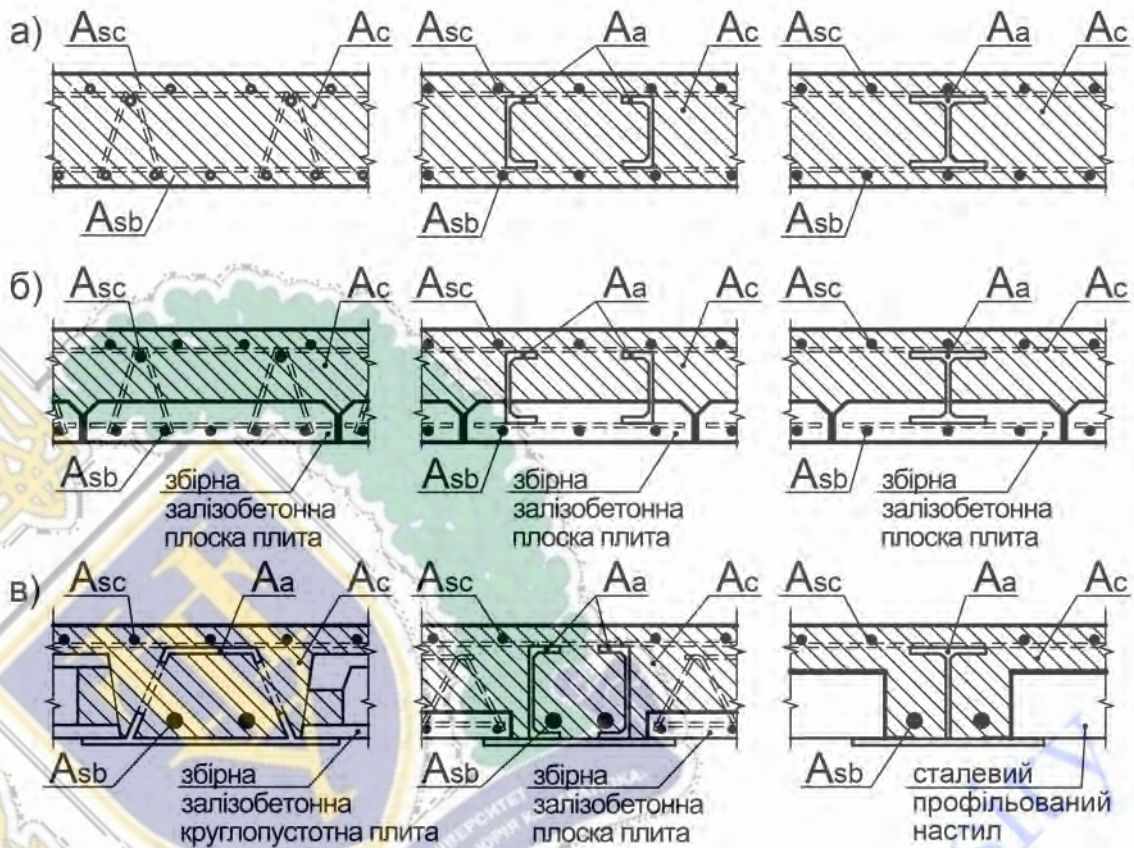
Варіанти поперечних перерізів плитних елементів ЗБ і СЗБ перекриттів: а) – монолітних залізобетонних та сталезалізобетонних; б) – збірно-монолітних залізобетонних та сталезалізобетонних із елементів нез'ємної касетної опалубки («lattice girder flat slab systems»); в) – гібридних «тонких» збірно-монолітних сталезалізобетонних із балковими елементами в рівень їх товщини («slim-floor systems»)
